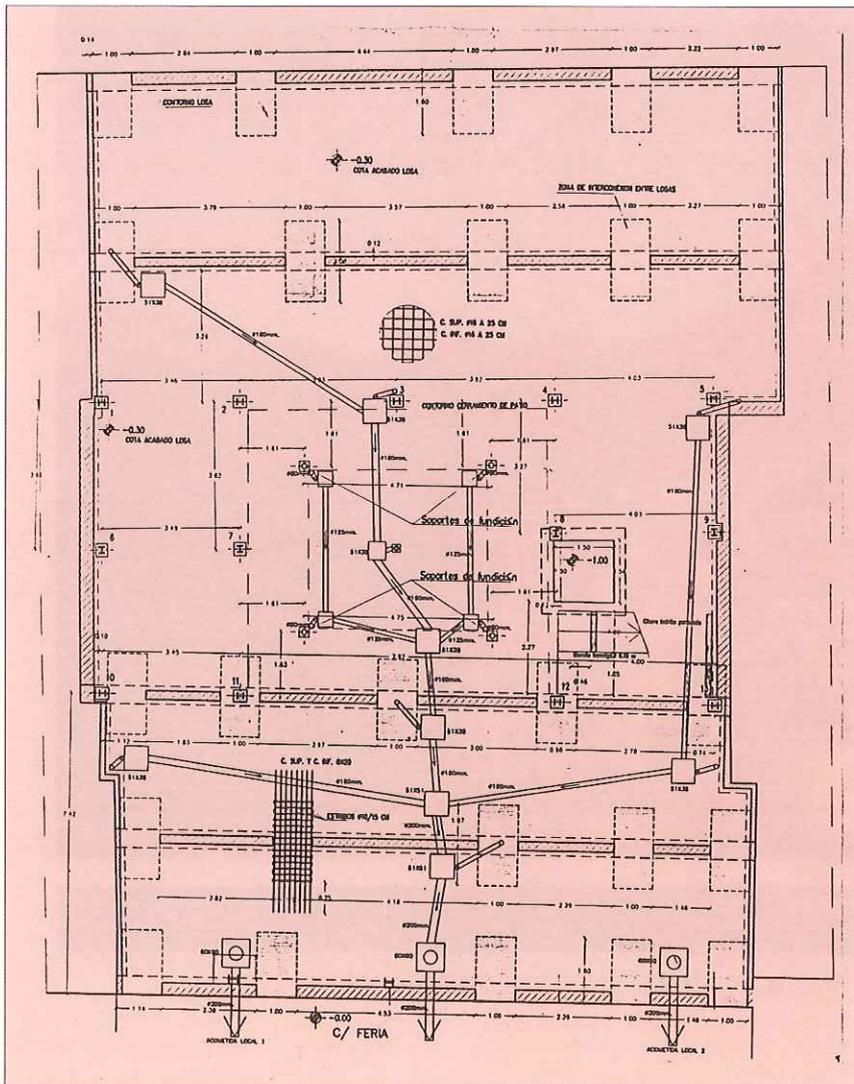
Planta de cimentación. Detalle de la ubicación de los zunchos en las regolas realizadas a los muros de carga.
